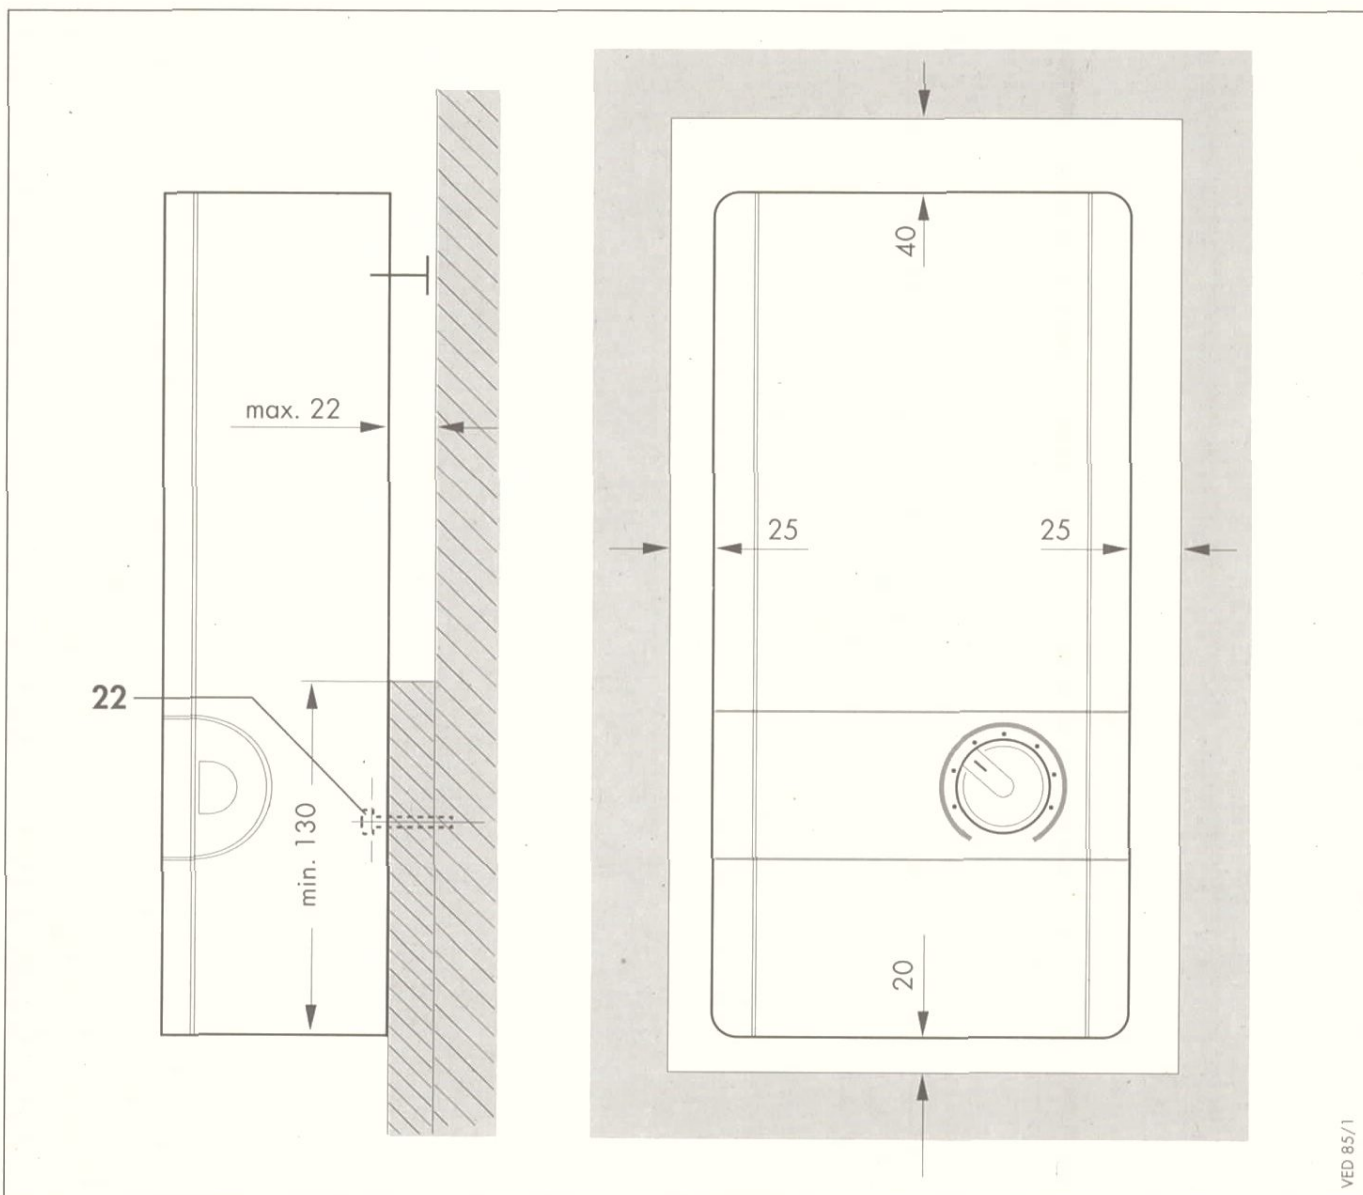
Installationswand mit Mindestabständen zur Umbauung in mm
